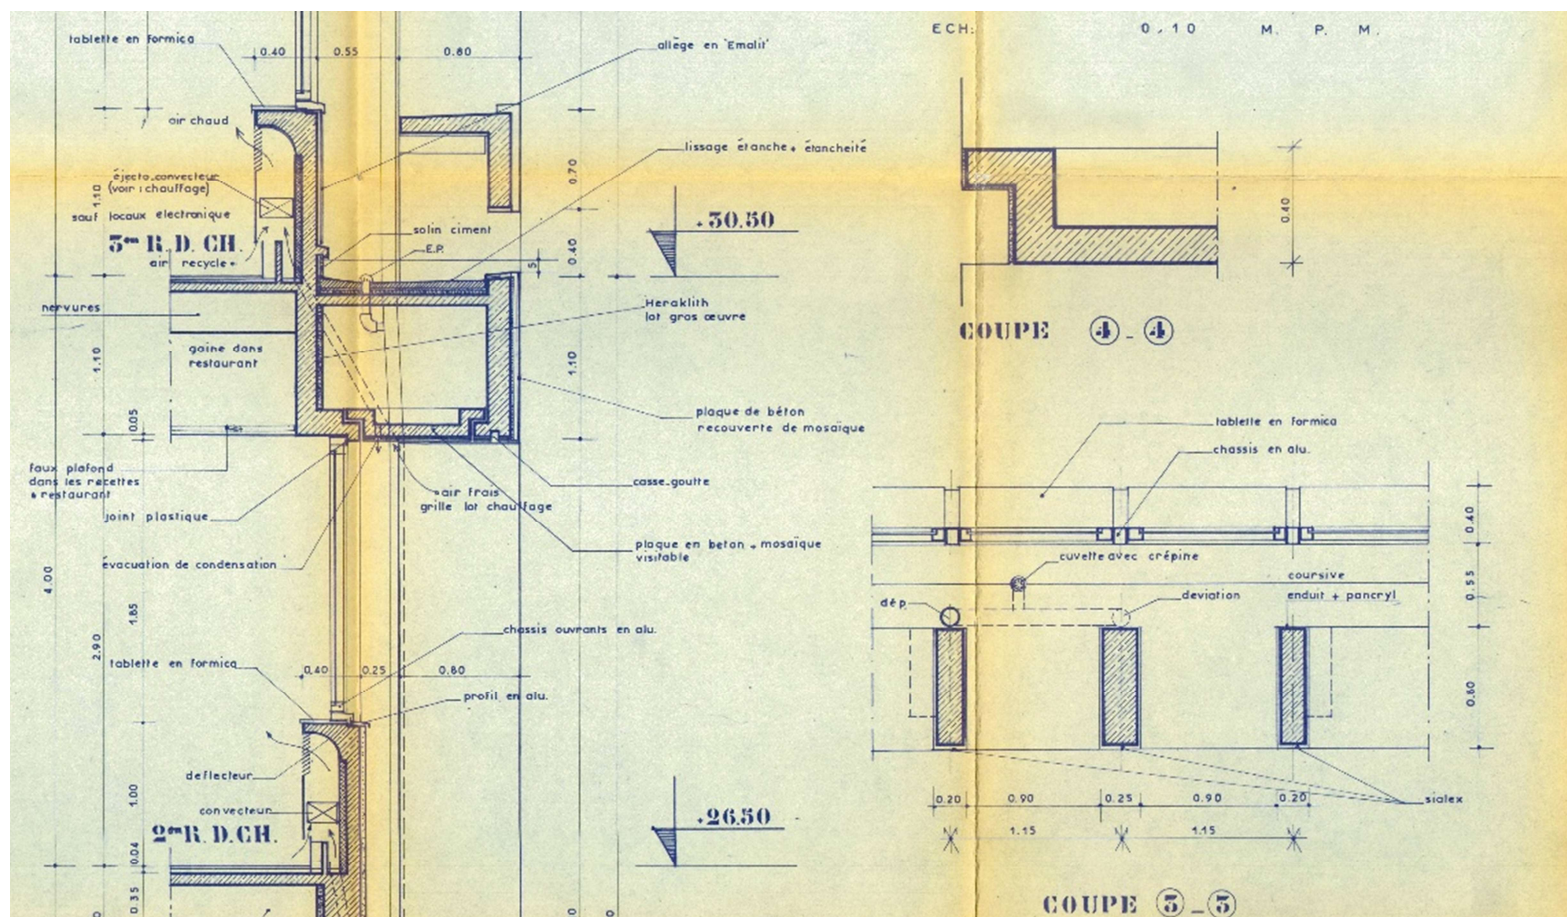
DETAILS DE CONSTRUCTION – FACADE ET COUPE DETAIL SUR LE SOCLE - Lors de la phase d'études de 1968-70
